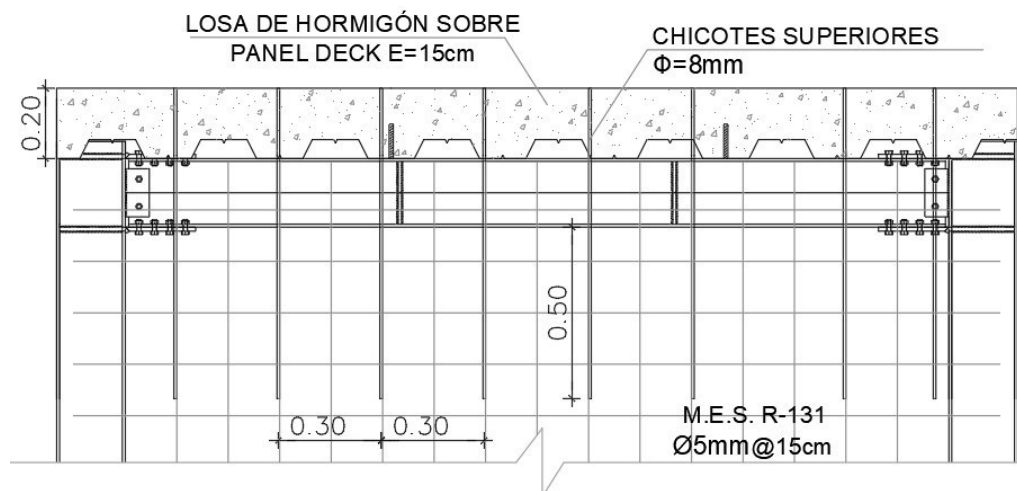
Esquema de conexión de enchape con la losa de hormigón.
